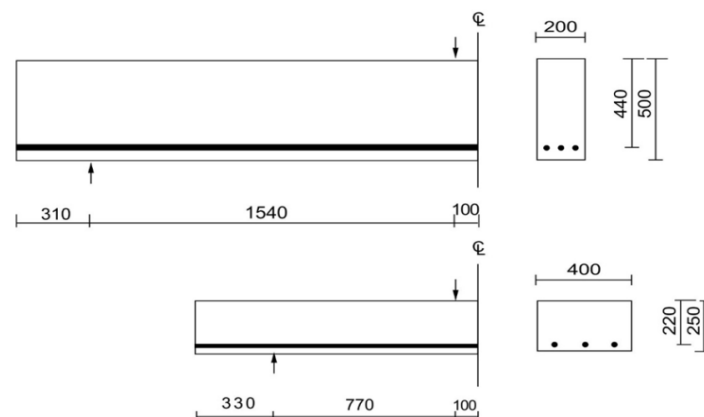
Configuração das vigas sem estribos, dimensões em mm (UEDA, 1982).
